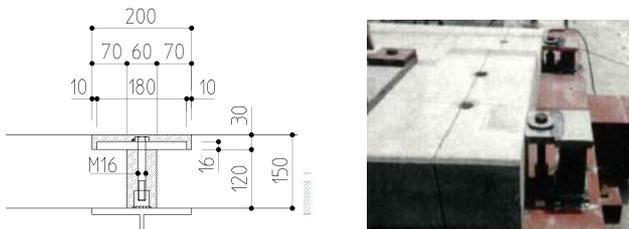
横桁との固定方法 写真-3 高ナットボルト固定
